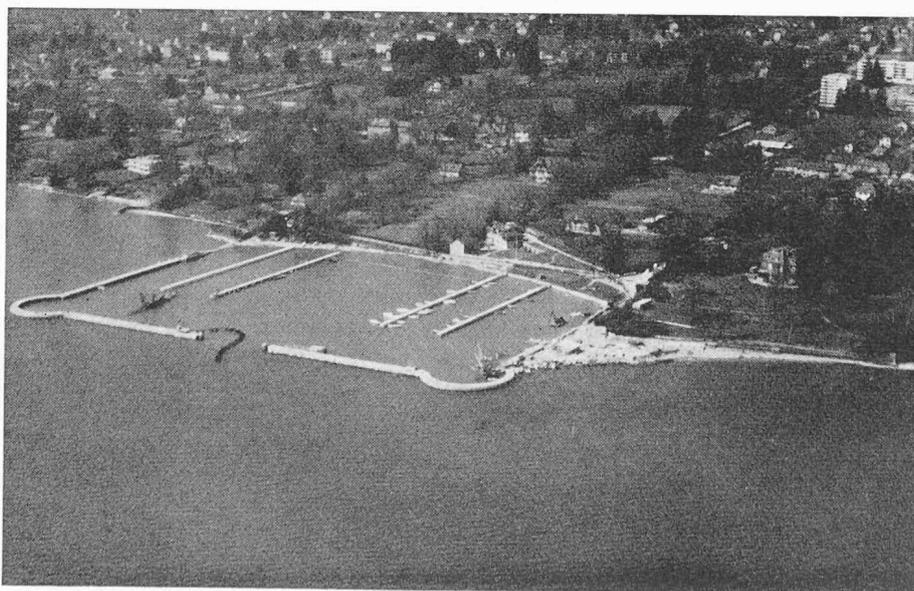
Le port et la plage de Versoix pendant la construction.
